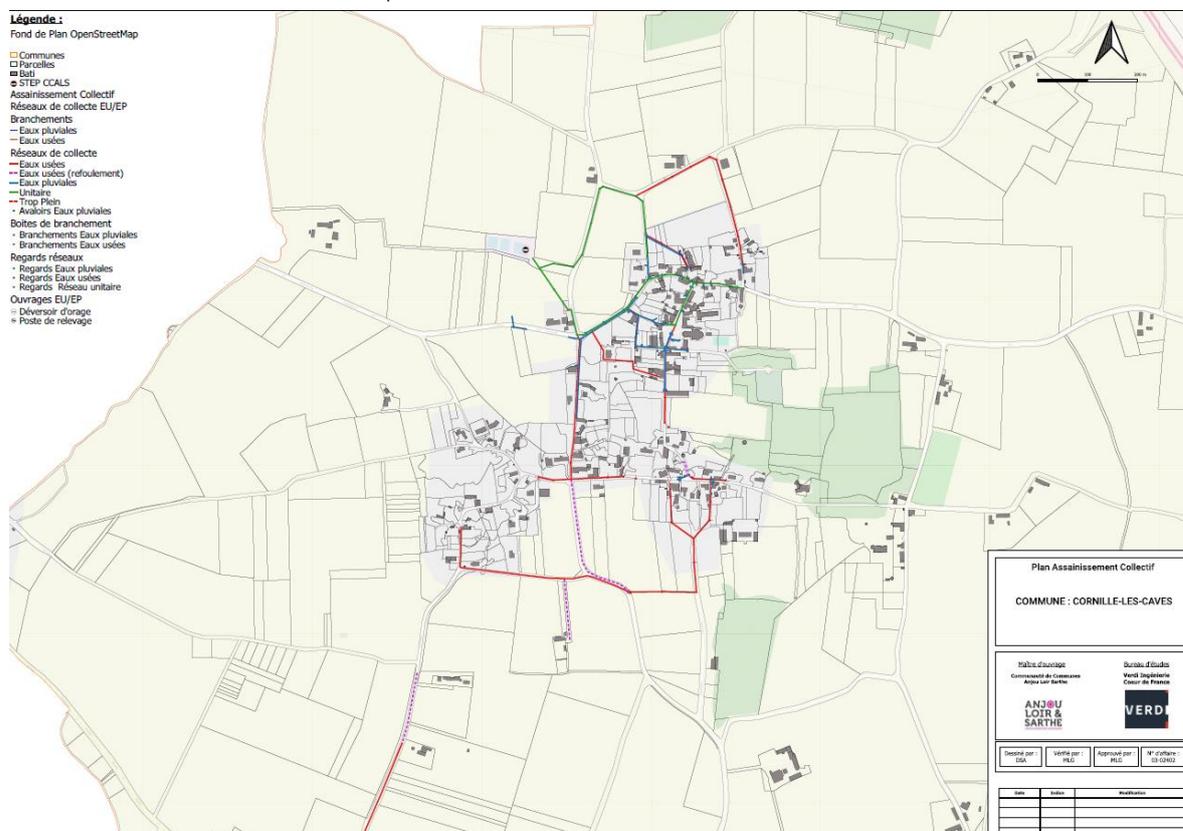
Plan de fonctionnement du réseau d'assainissement du secteur bourg
